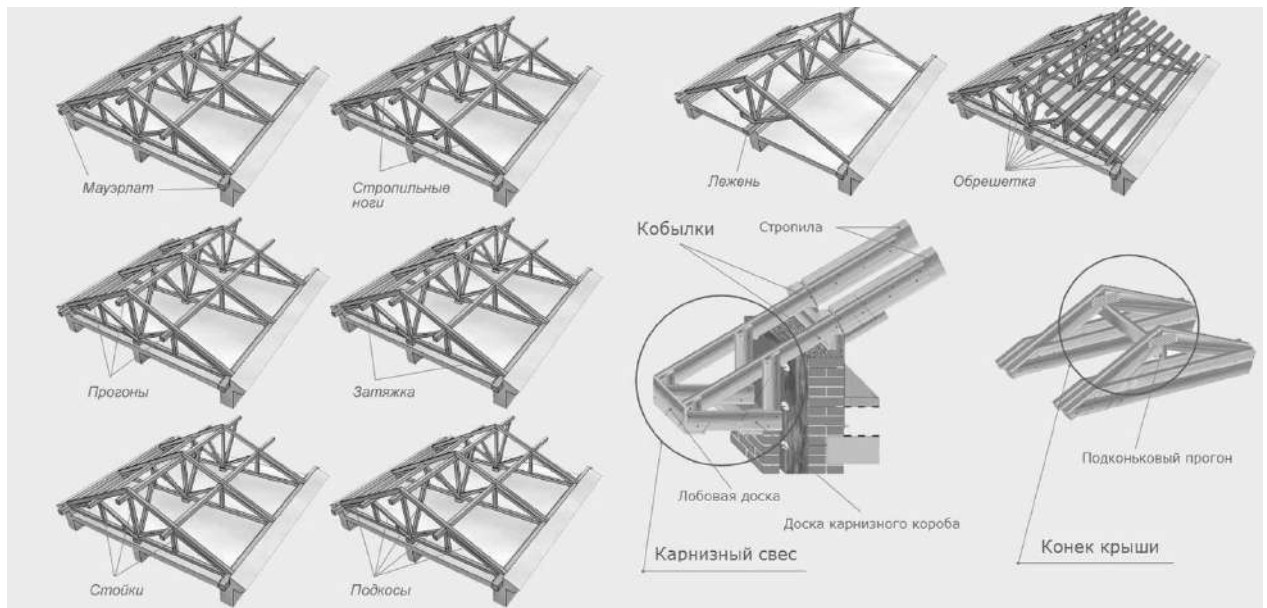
Элементы стропильной системы на примере двускатной крыши
